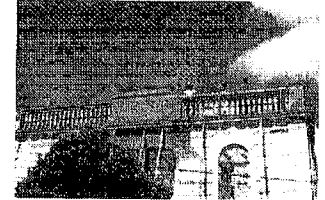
Detalhe das obras de restauração do Paço Municipal, na fachada, no ano 2000.
